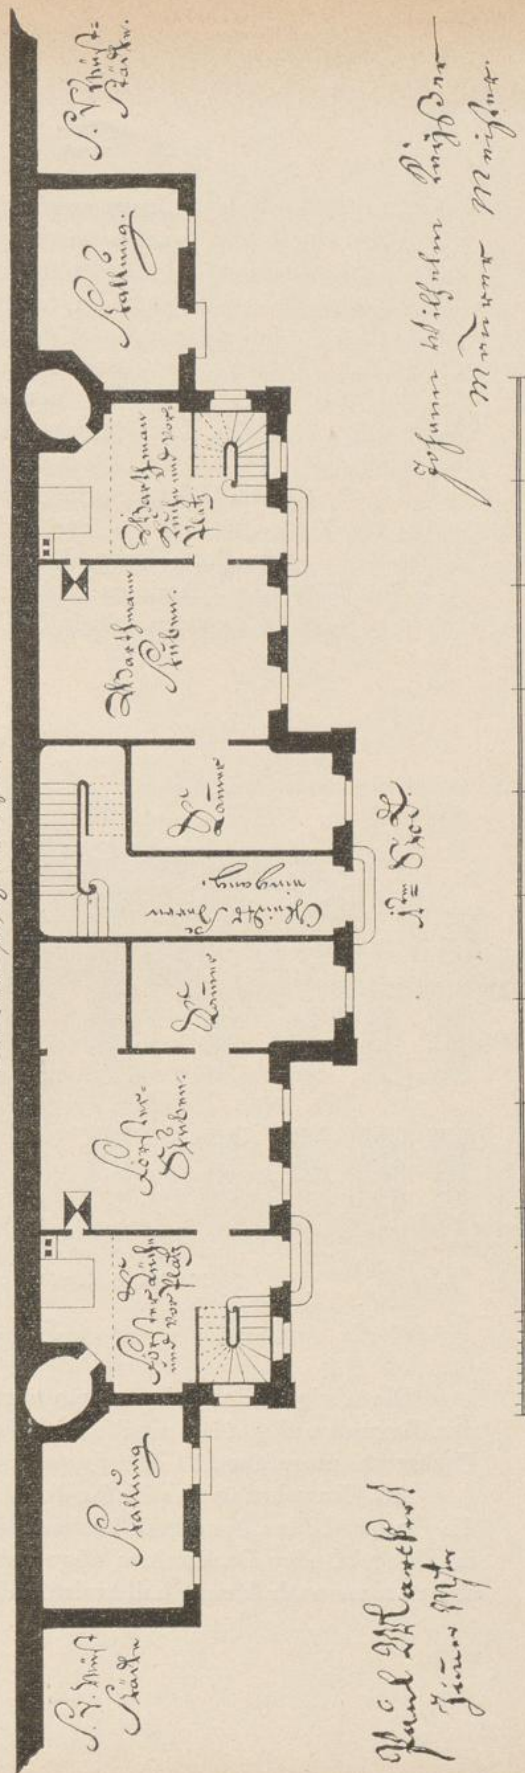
Sachsenhäuser Warte; Grundrisse des Wohnhauses.
